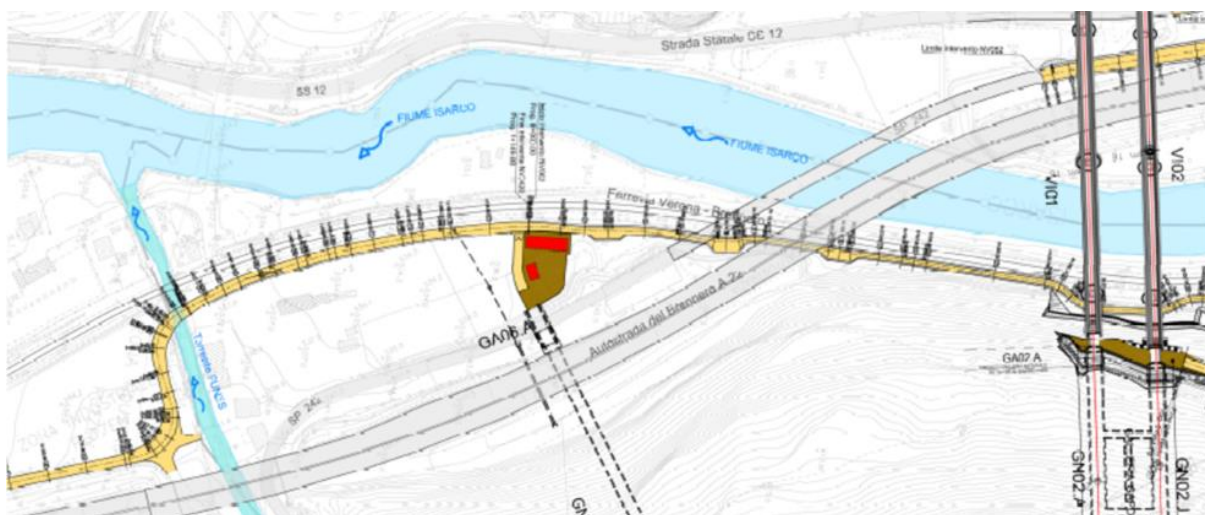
Planimetria viabilità accesso piazzale Funes NV042
